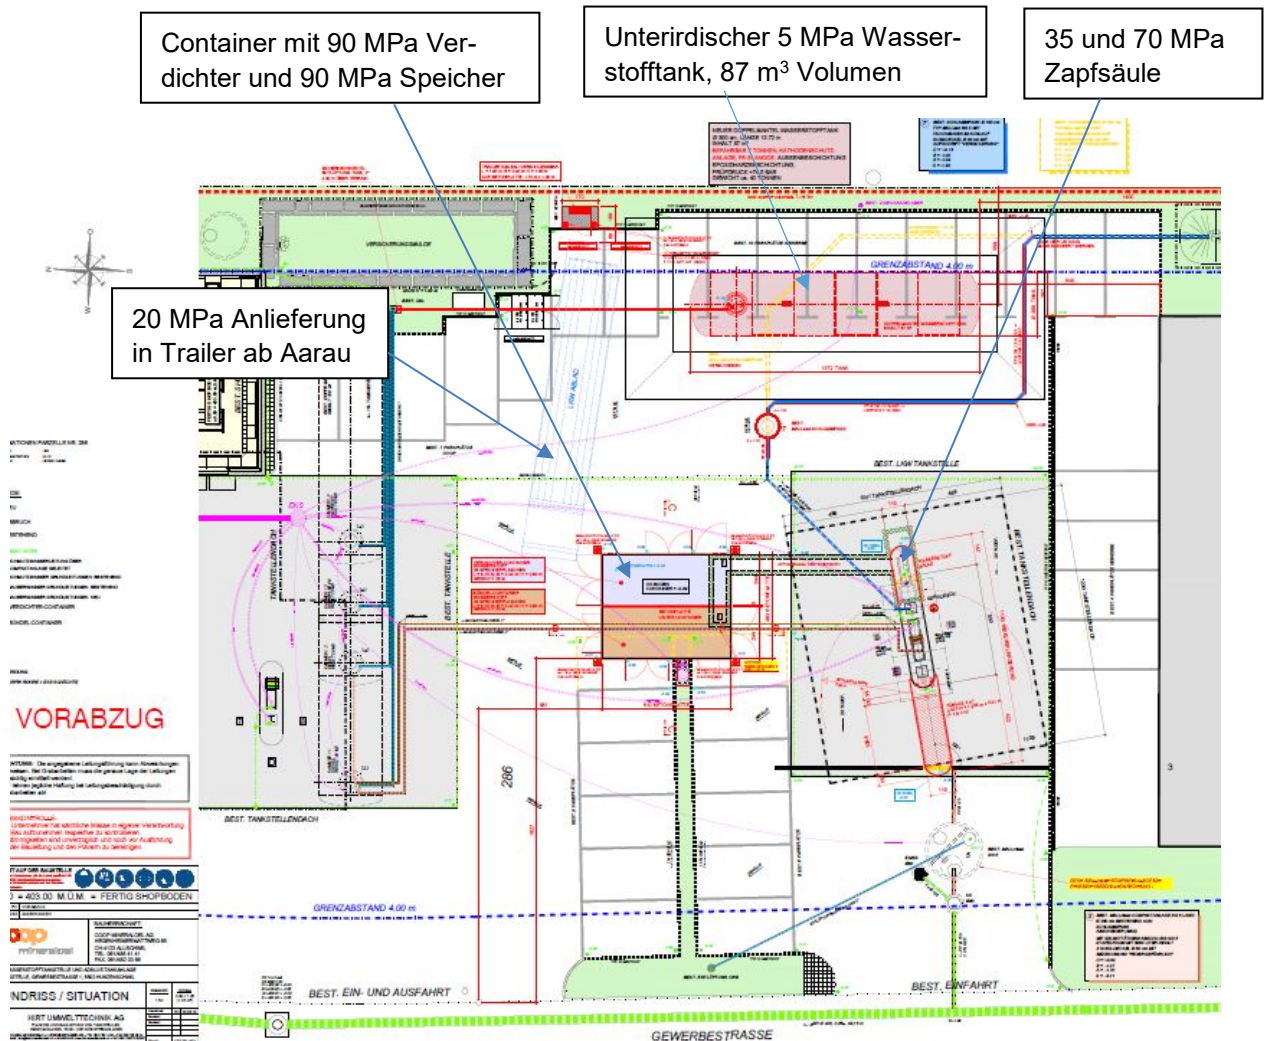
Grundriss der Coop-Tankstelle in Hunzenschwil mit ergänzten Komponenten zur Betankung von Wasserstoff (Quelle: CMA)
